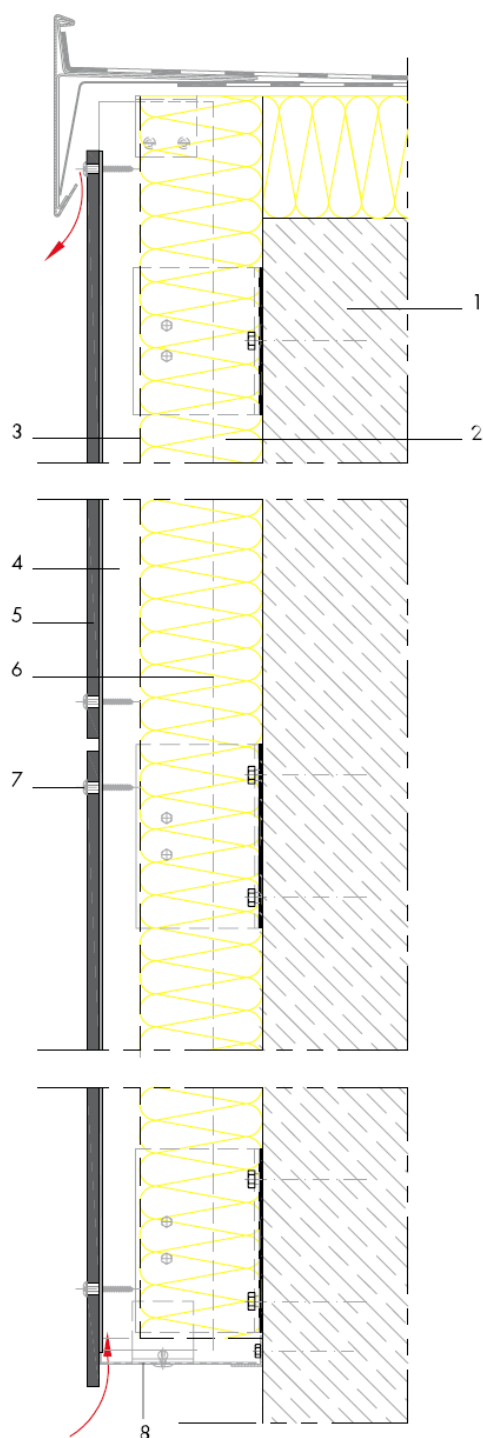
Coupe verticale d'une fixation de panneau avec vis
